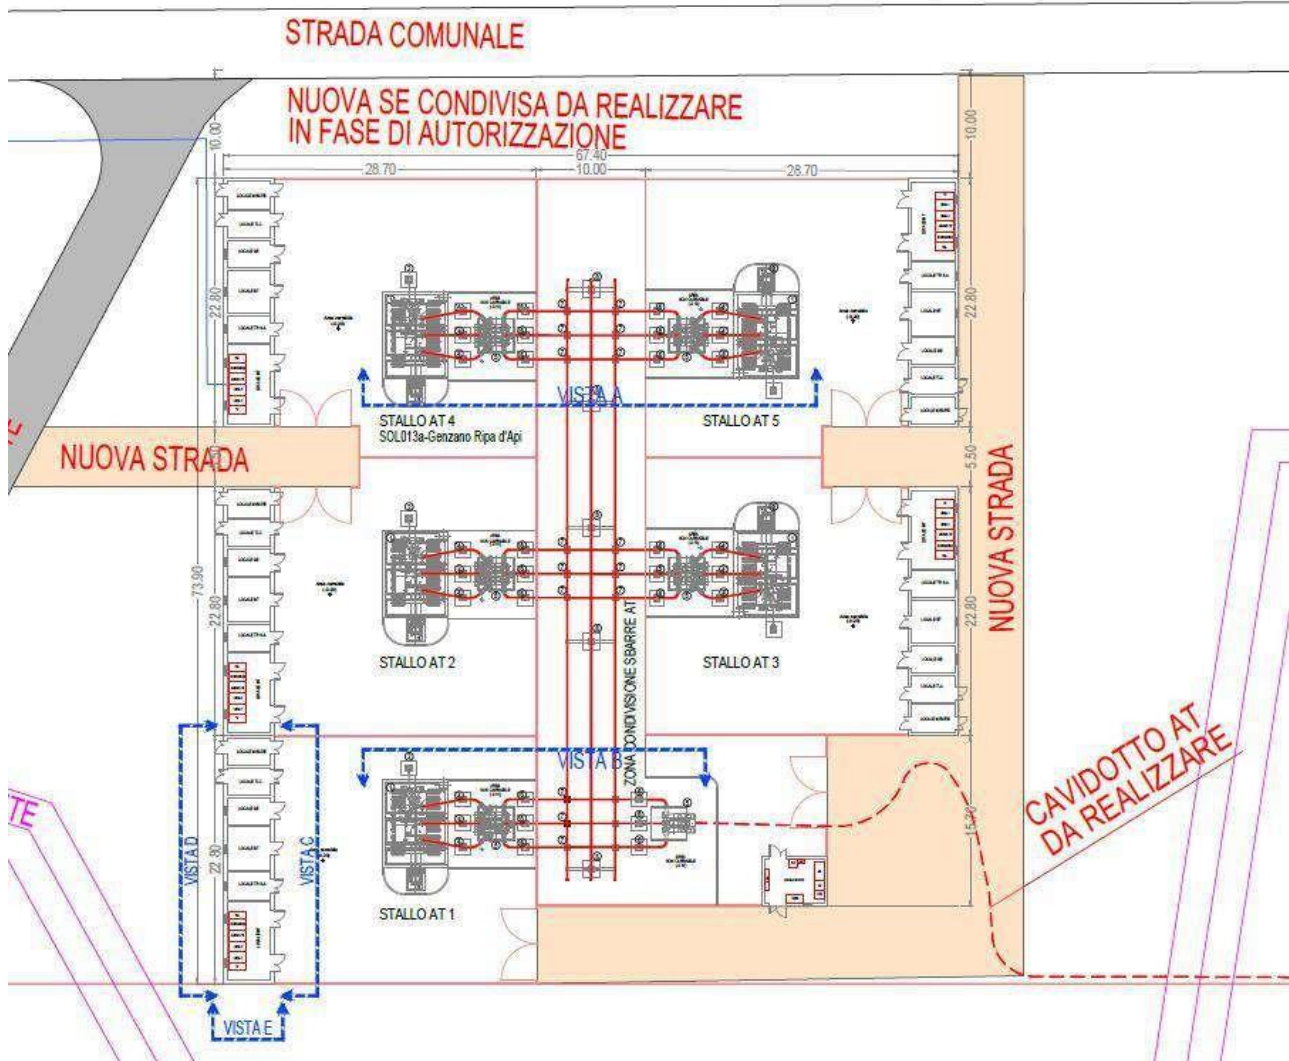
LAYOUT DELLA SOTTOSTAZIONE CONDIVISA
